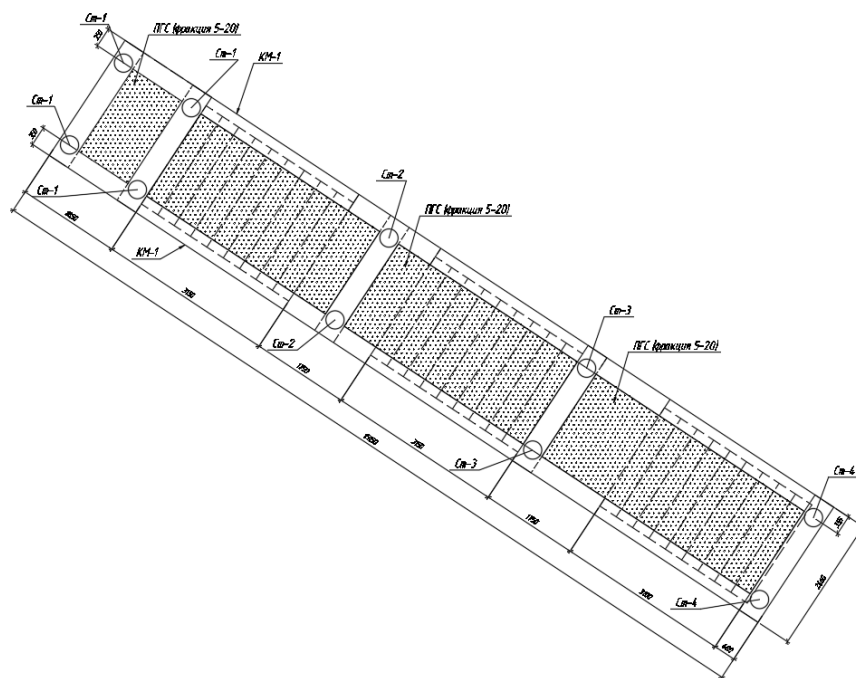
Схема расположения стальных свай и монолитных косоуров
